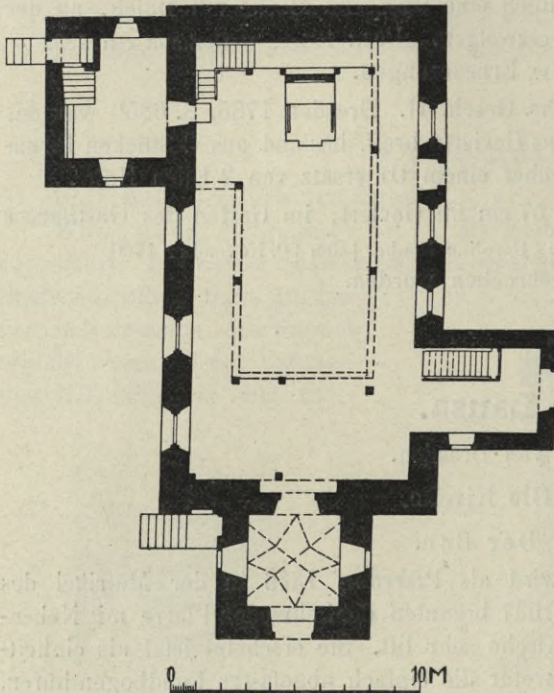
Lausa, Grundriss der Kirche.
